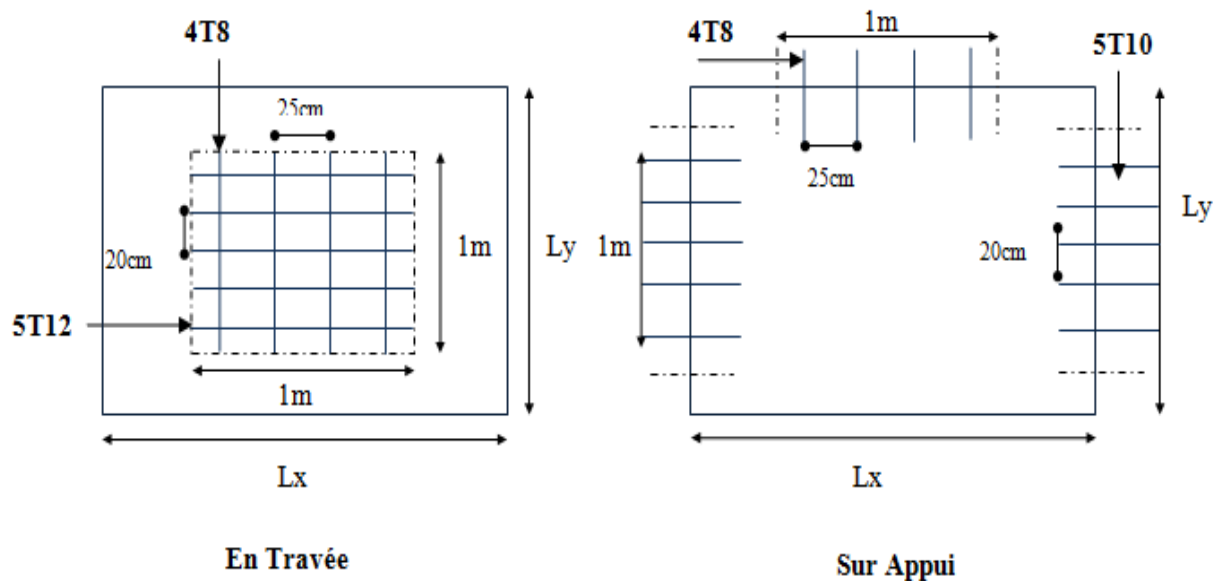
Ferrailage de plancher de Sous-Sol 3.
